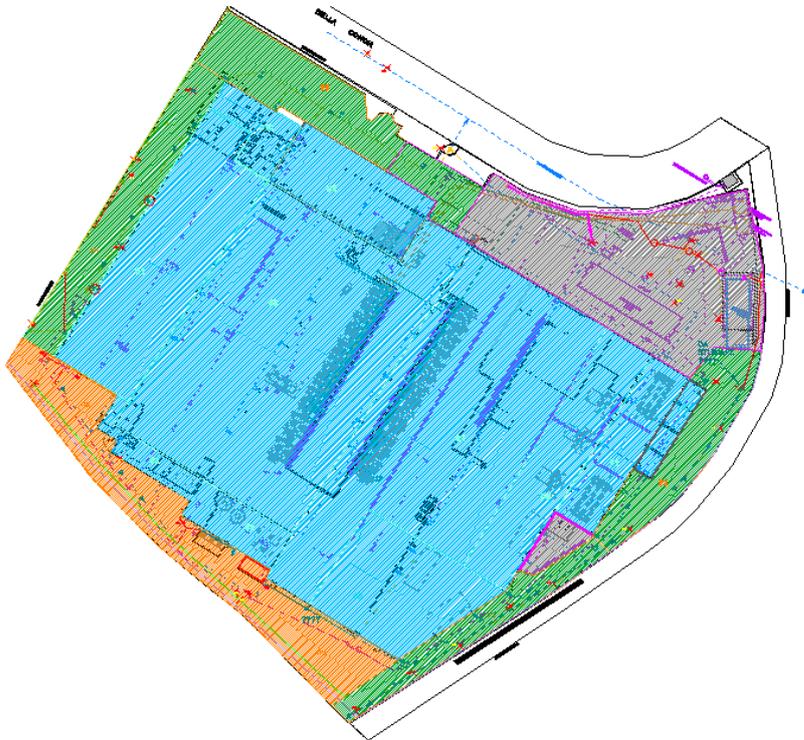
Stralcio planimetrico dello stabilimento: in azzurro coperture, in grigio aree dilavamento industriale, in verde aree parcheggio maestranze, in arancione piazzali.
